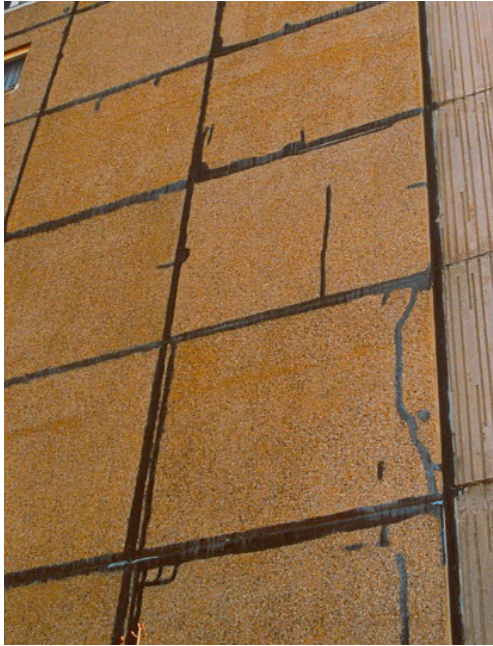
■ Mit Morinolkitt nicht fachgerecht sanierte Risse in den Witterschutzschichten von Beton-Sandwichwänden (östliche Bundesländer)
